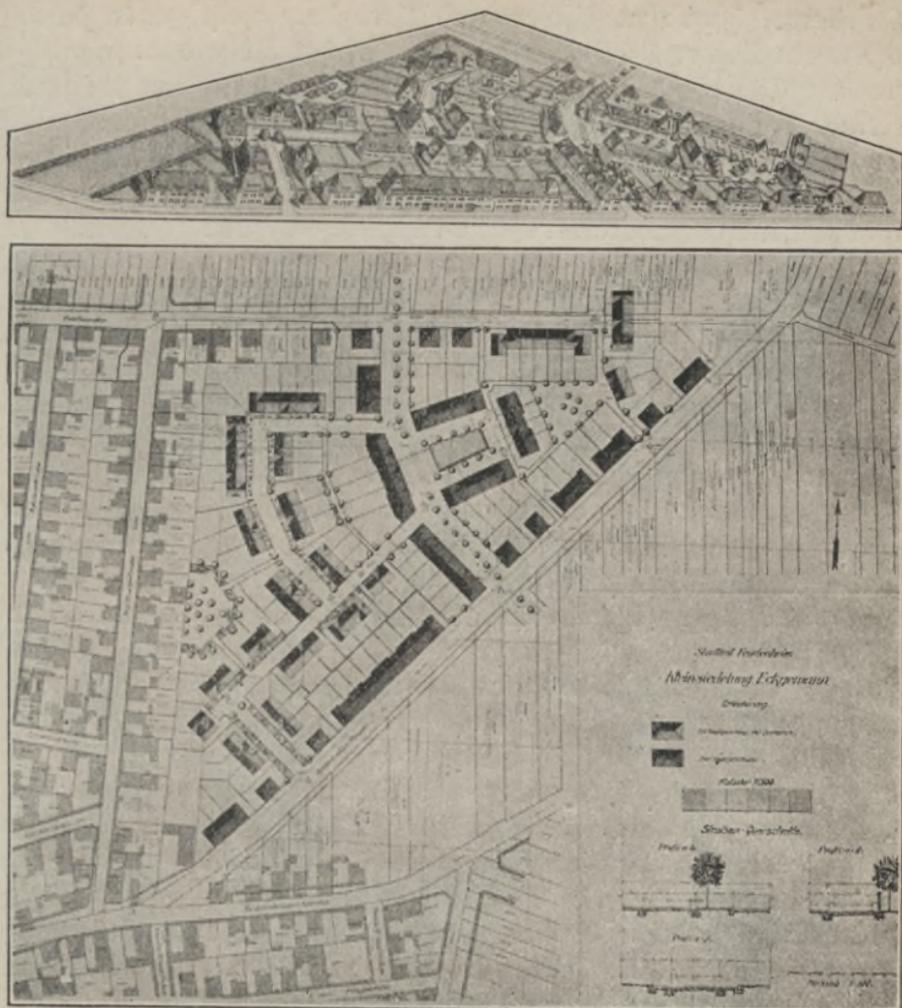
Kleinhausfiedelung Edgewann auf Gemarkung Mannheim, Schaubild und Lageplan. (Verfasser: H. Ehlgöb in Essen.)
